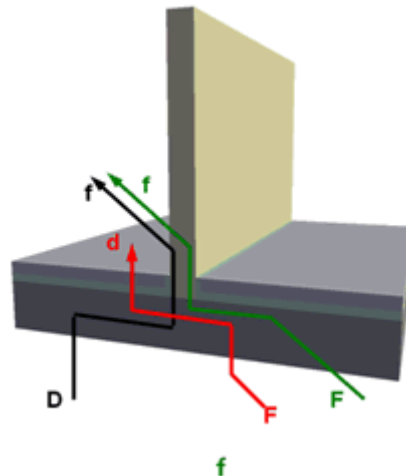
T-Stoß einer Innenwand auf einer Decke bei versetzten Grundrissen
